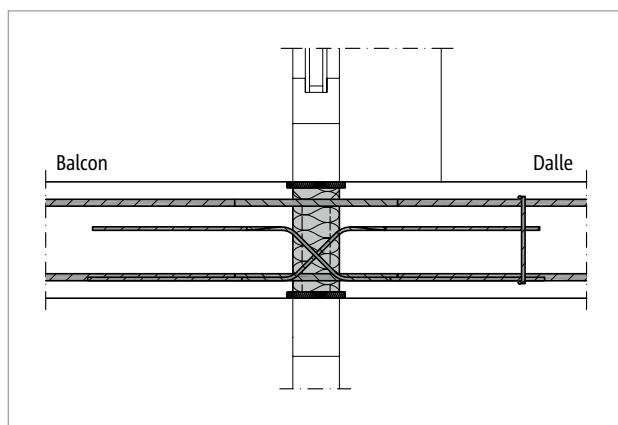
Schöck Isokorb® T Type D : Coupe de montage ; plancher à axe unique
